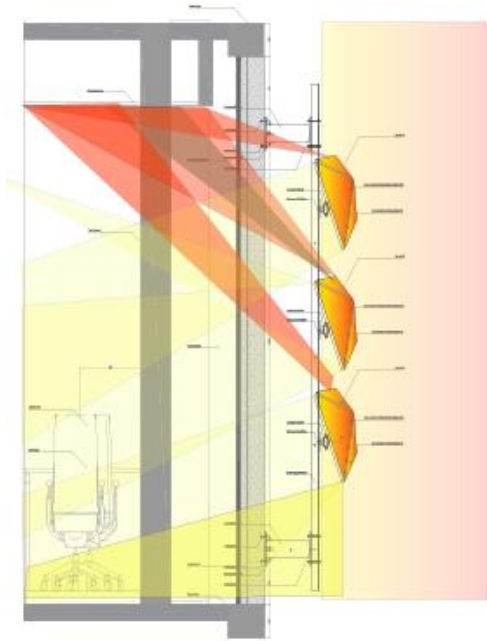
Ingreso Solar fachada calle 11. Elaboración propia.
